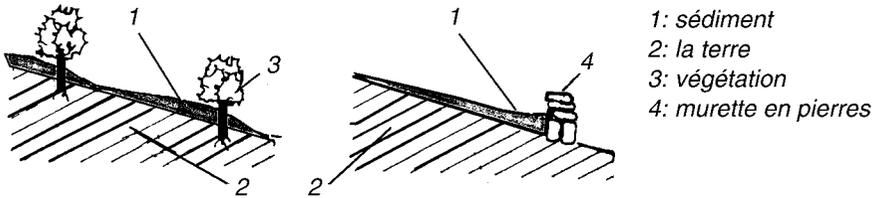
Formation d'une terrasse à l'aide d'une ligne de végétation ou d'une murette en pierres.
